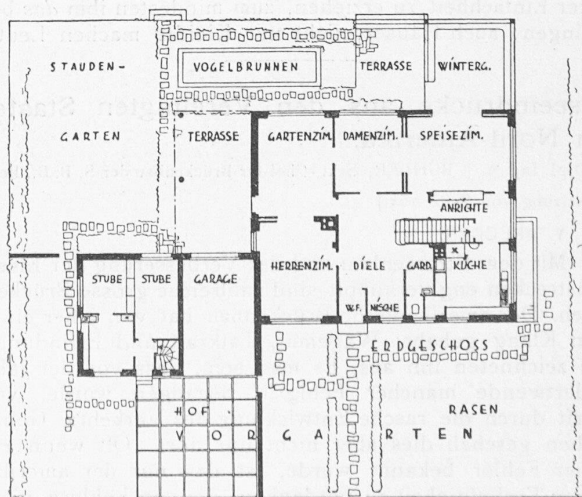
und 5. Grundrisse zum Hause Dr. Charlton in Dahlem. — 1:400.
